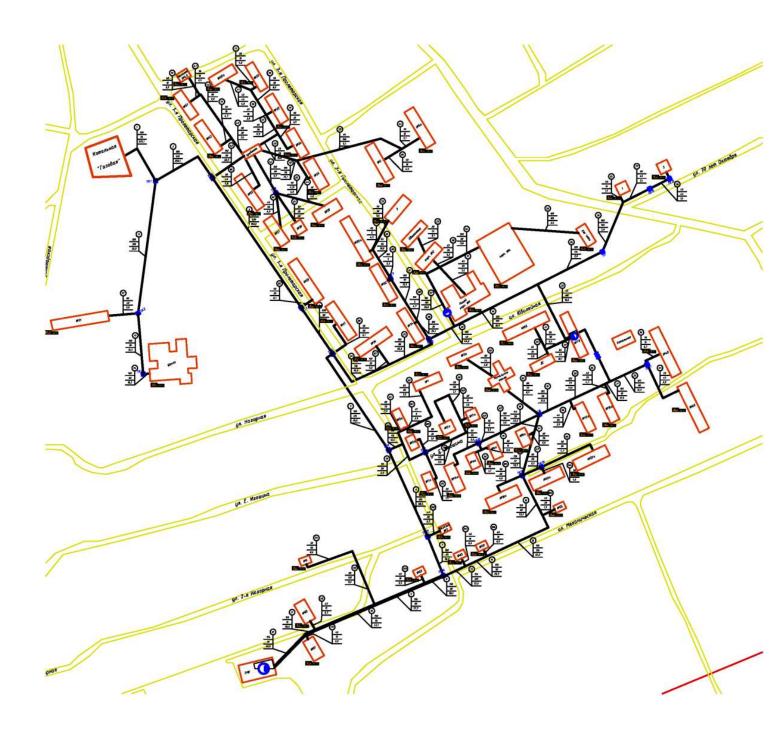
Схема сравнения расчётных и фактических тепловых нагрузок по котельной 1 Газовая
